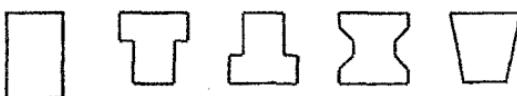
Формы поперечного сечения железобетонных балок
